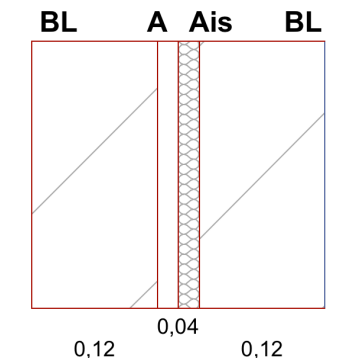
Sección muro compuesto, bloque de arcilla + aislamiento.
